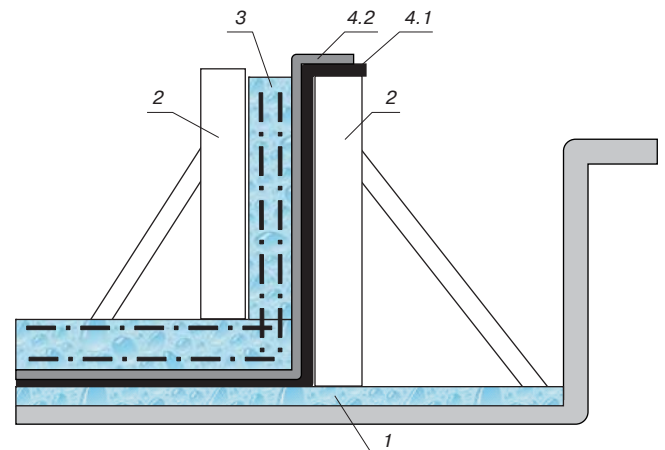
Схема подготовки бетонного фундамента с гидроизоляцией ЭПИКРОМом к заливке бетонной смеси в опалубку: 1 – бетонное основание; 2 – опалубка; 3 – бетонная смесь; 4.1 – предварительно склеенный в крупноборный изоляционный ковер ЭПИКРОМ; 4.2 – дублирующий нетканый материал
